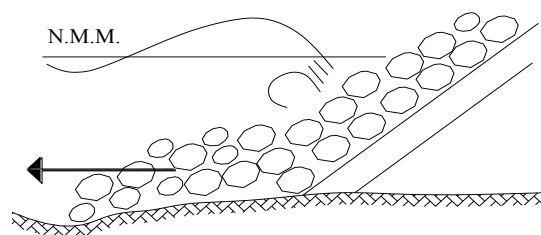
Esquema da rotura típica da fundação de uma obra longitudinal aderente devido a subescavações (Lima, 2011, baseado em CIRIA *et al.*, 2007a).
